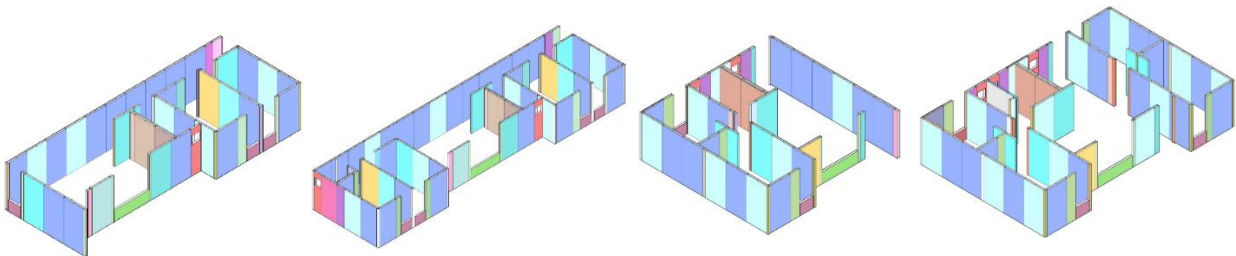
Tipologías de vivienda basadas en sistema de paneles estandarizados (Fuente: Ñande')
